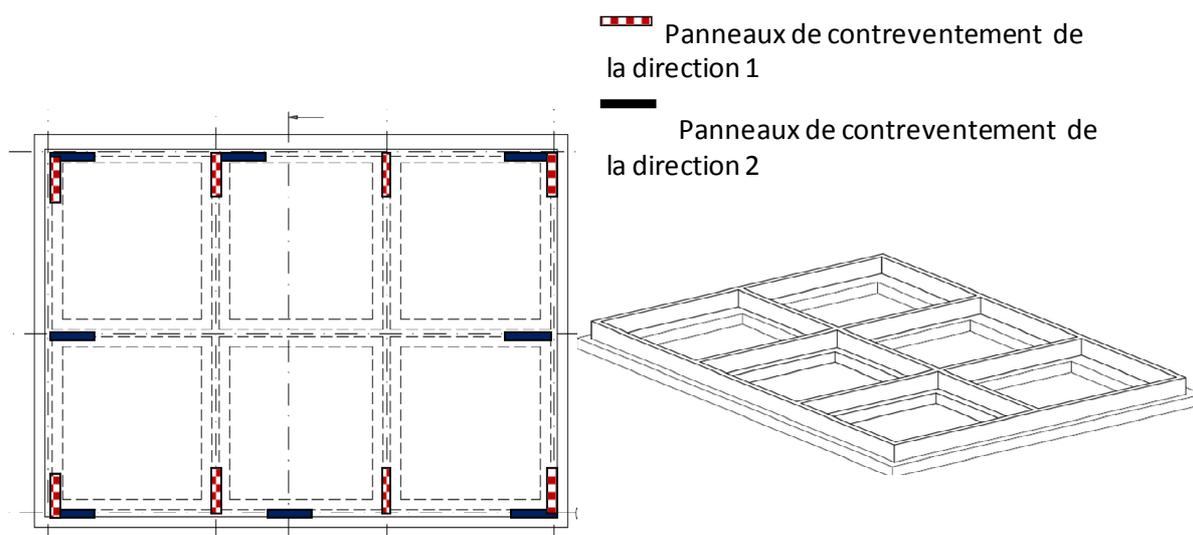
Exemple de réseau de semelles filantes approprié à un système de contreventement donné, vu en plan et en axonomie.
